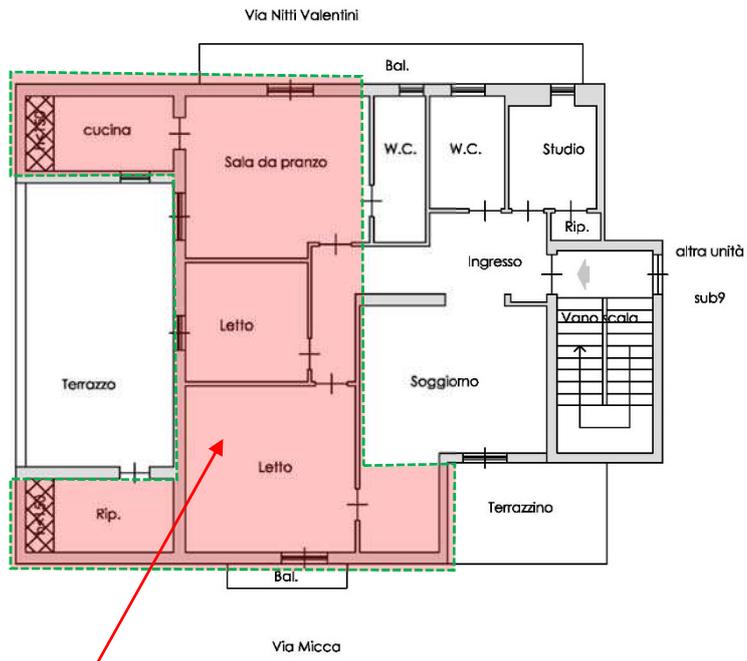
BENE D- Planimetria stato di fatto (da rilievo)
